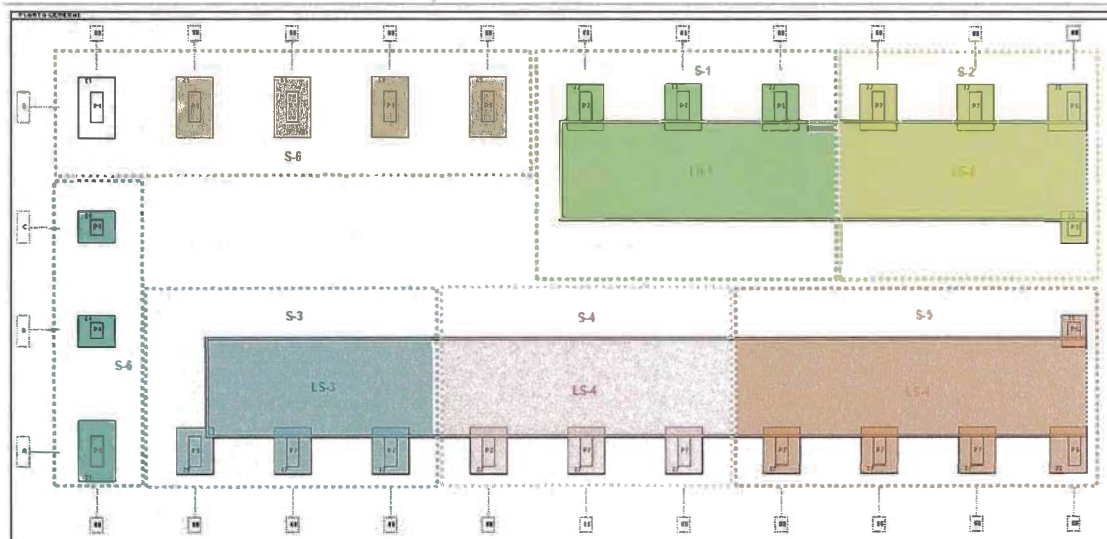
Sectorización en planta de Faja 1 y 5 (Fuente propia)
